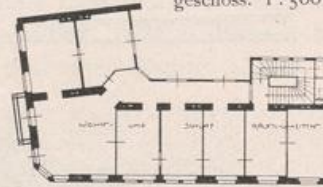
Klosterstrasse 68 a. Obergeschoss. 1:500.
